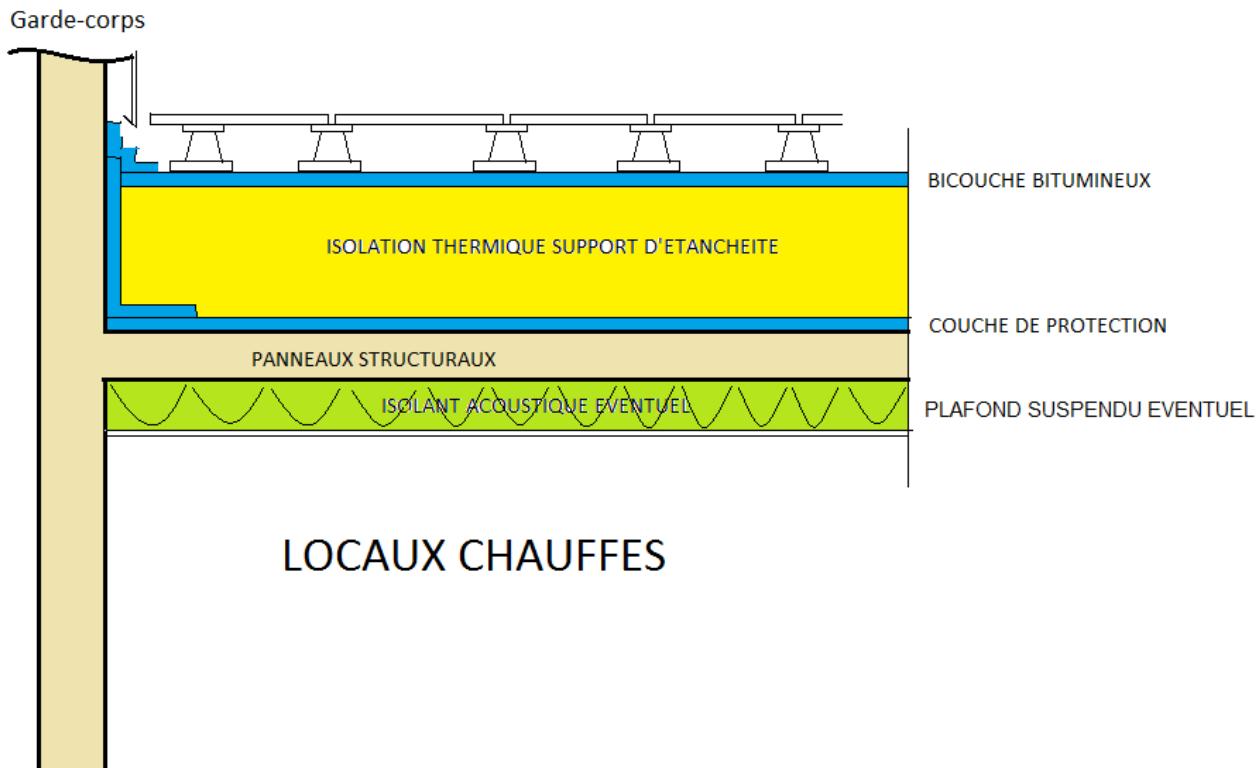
Principe de toitures terrasses accessibles aux piétons avec protection par dalles sur plots (isolation support d'étanchéité) (coupe perpendiculaire à la pente)
